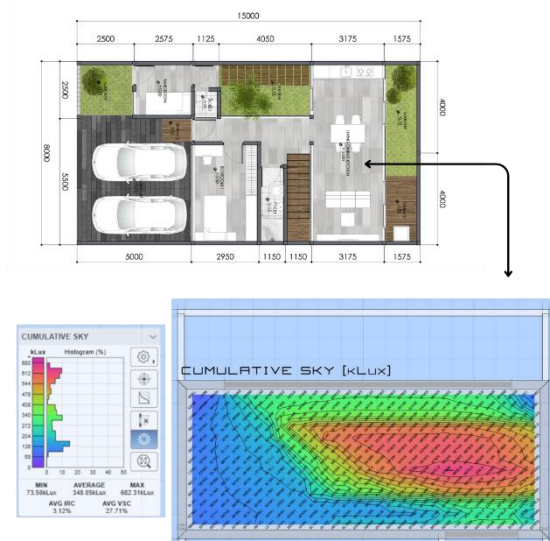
Denah Lantai 2 Rumah Permata Hijau (sumber: PT. JOSO, 2024)
